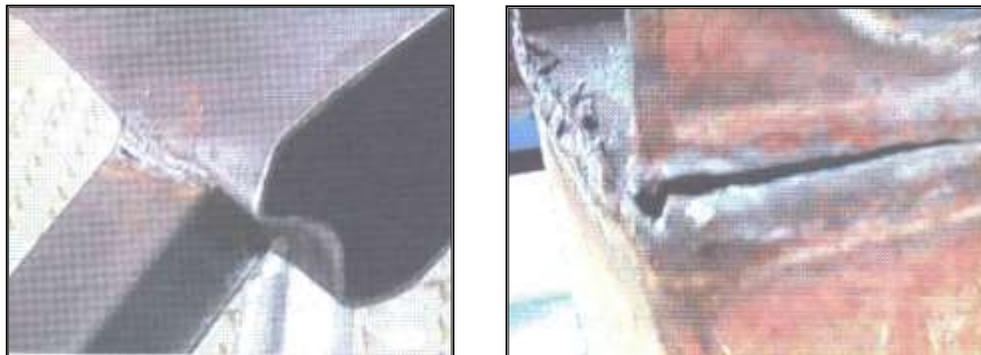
Fallas en ensayos de conexiones directas entre STT.
